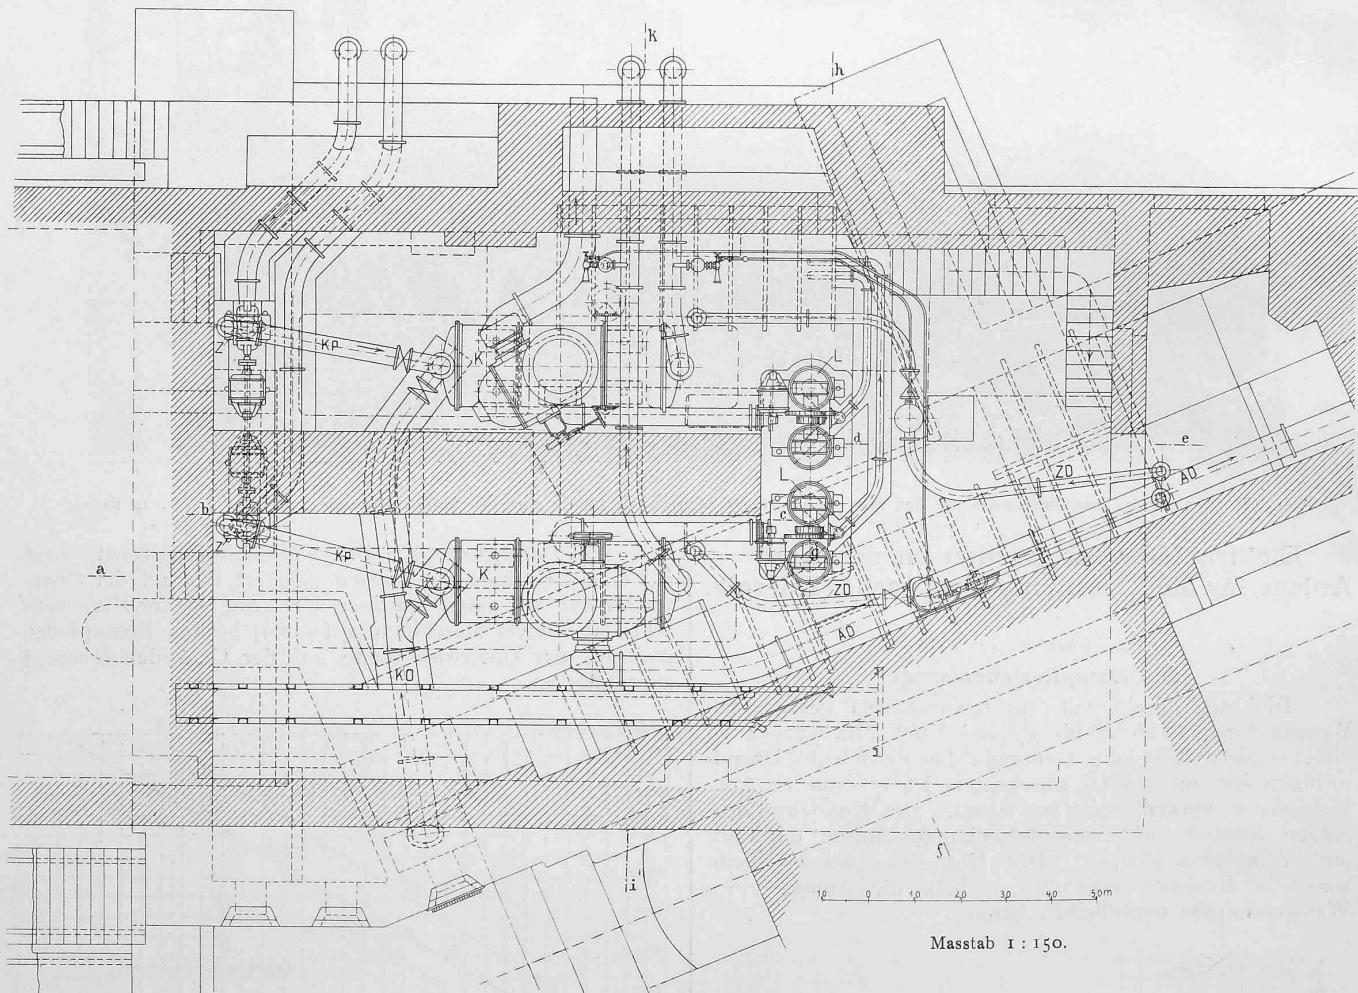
Horizontalschnitt auf Kote 329, 10 durch das Kellergeschoß der Dampfturbinenanlage.
